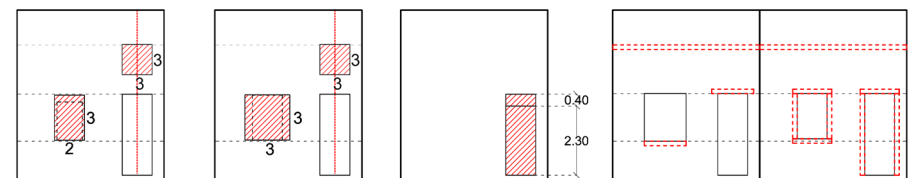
Propuesta Lineamientos Plan Seccional, Fachadas.
